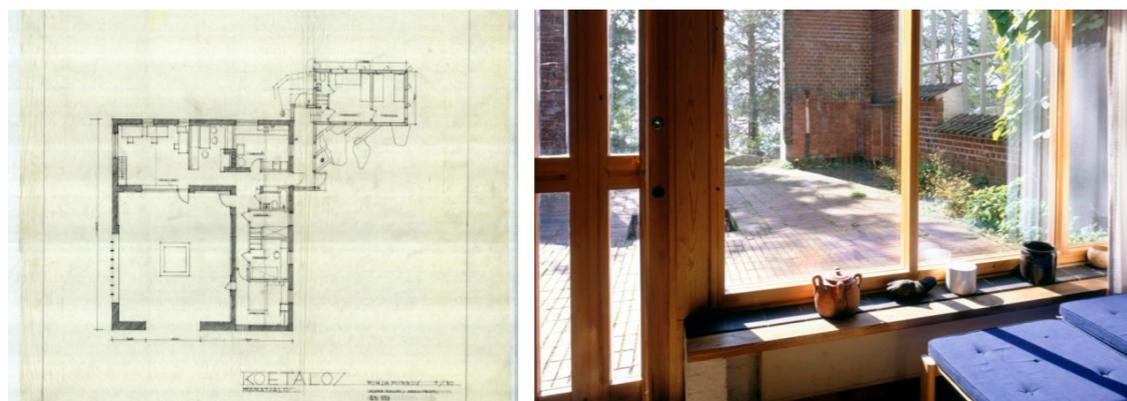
Planta baixa (à esquerda) e vista ao pátio interno (à direita, da Muuratsalo Experimental House
